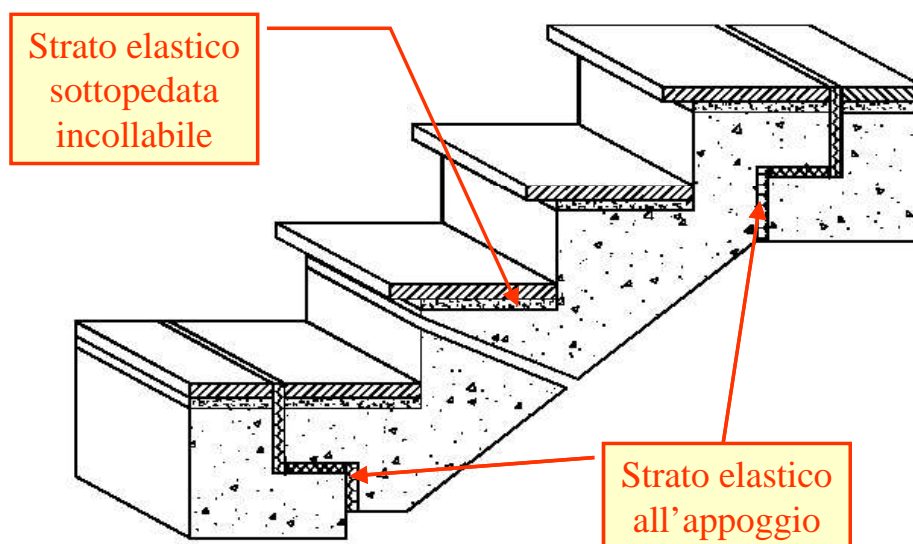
Scala con rampa staticamente indipendente e materiale elastico sotto la pavimentazione
